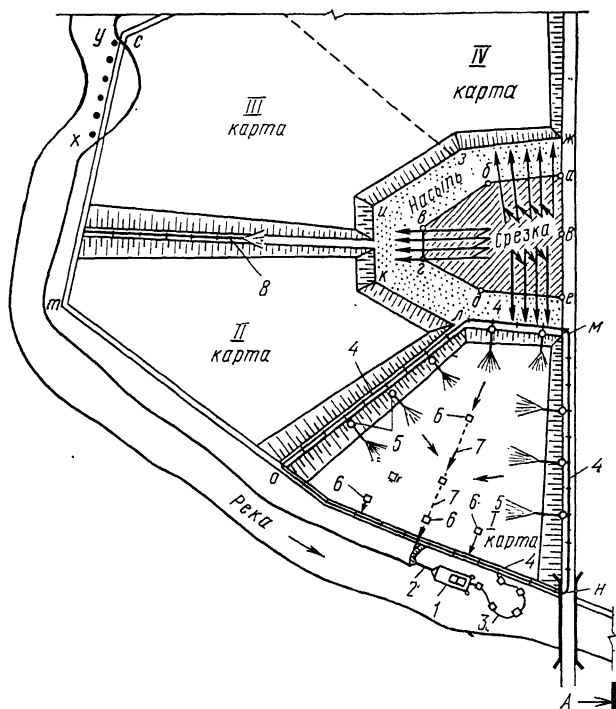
Схема разработки грунта плавучим земснарядом с перекачкой пульпы на карты намыва
